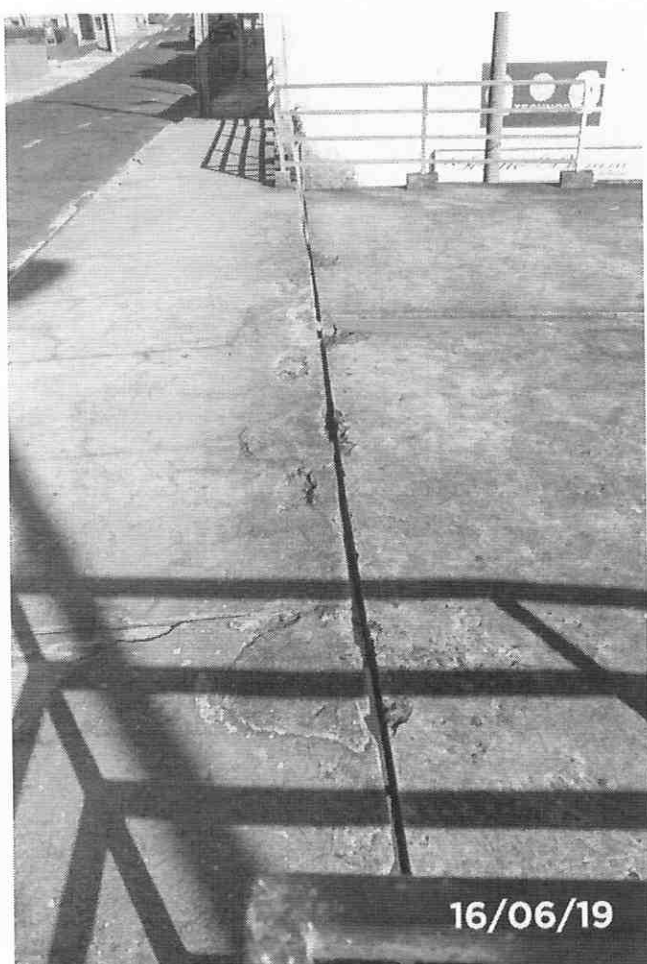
Detalhe da junta de dilatação entre Av. Brasil e a Passarela, apresentando segregação do concreto, trincas, deslocamento do concreto do Passeio.
